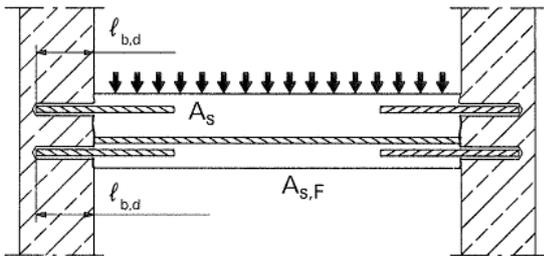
Ancrage direct d'armatures pour un élément principalement sollicité en compression. Les armatures subissent une contrainte de compression
